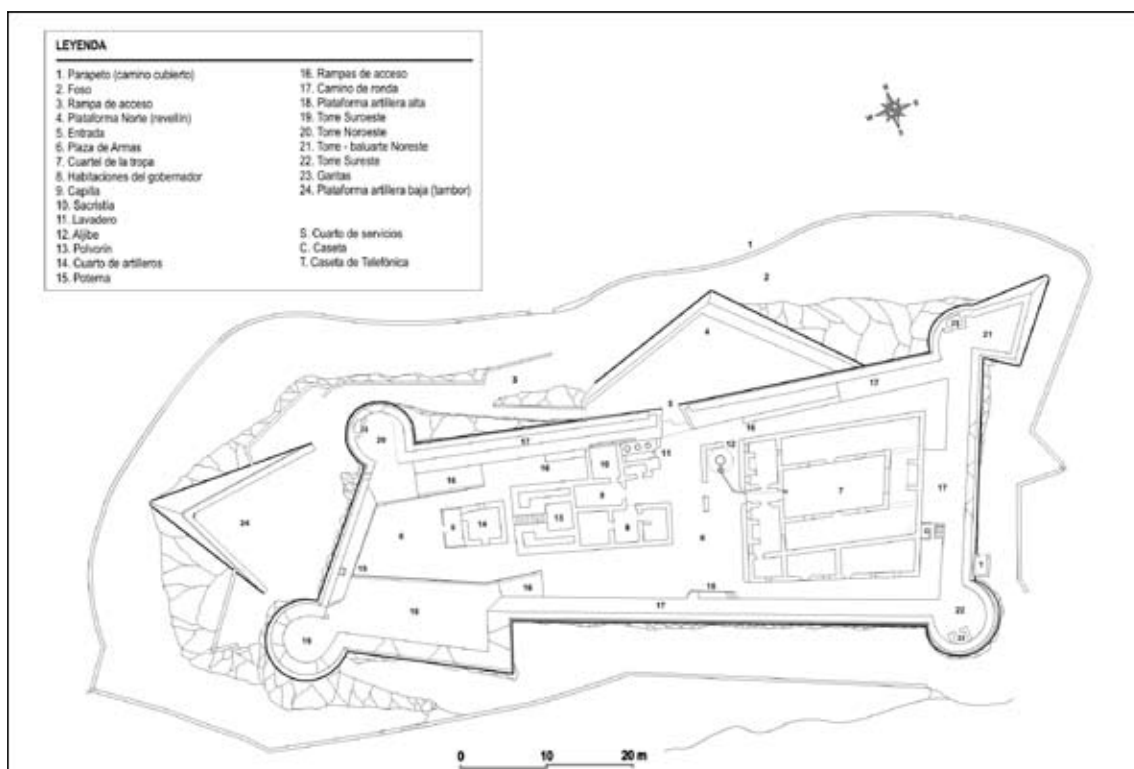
a. Planta del Castillo de Sanlúcar de Guadiana. Estado de conservación.
